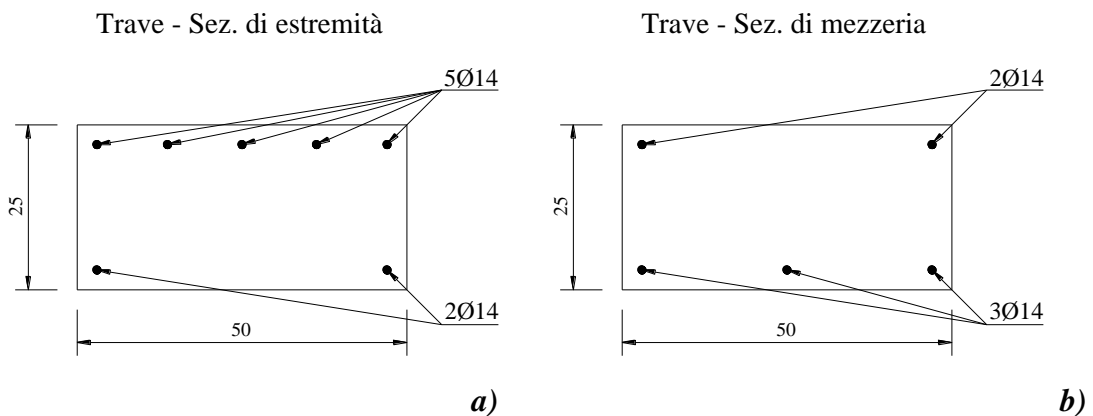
Sezioni delle travi: *a)* sezione all'estremità, *b)* sezione di mezzeria.
